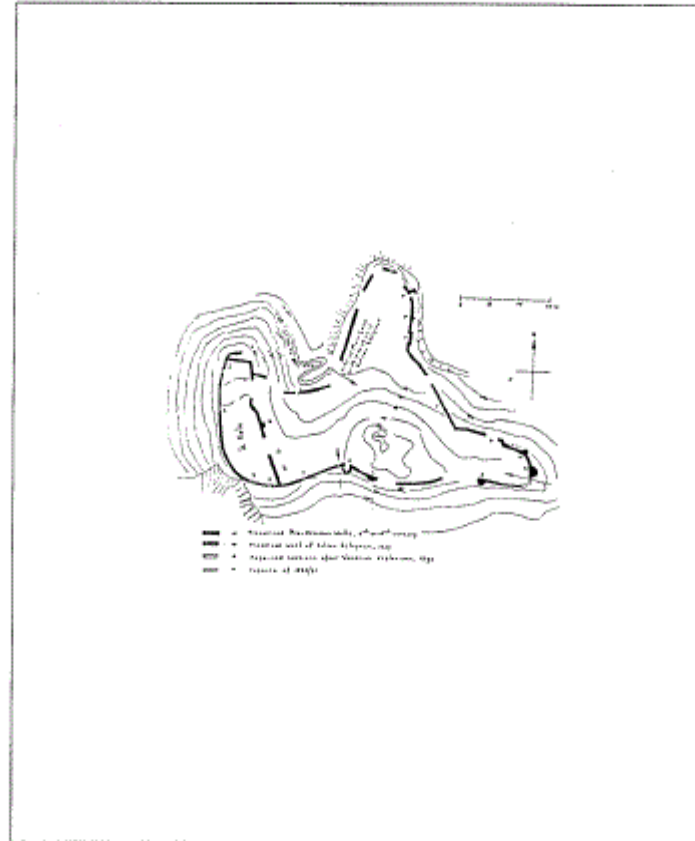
مسقط أفقي لقلعة برفيزه بألبانيا (عن : كجيل) .
